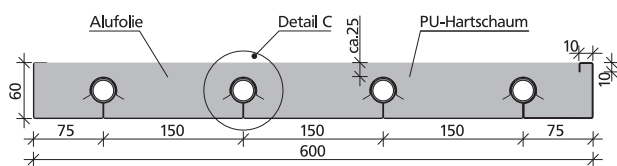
d Strahlflächenpaneel mit Abdeckblechen
